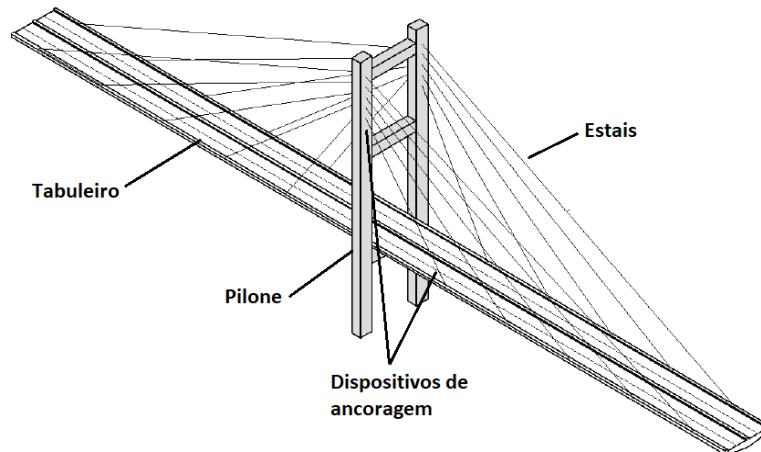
Elementos que constituem uma ponte estaiada. (adaptado de MAZARIM, 2011)
